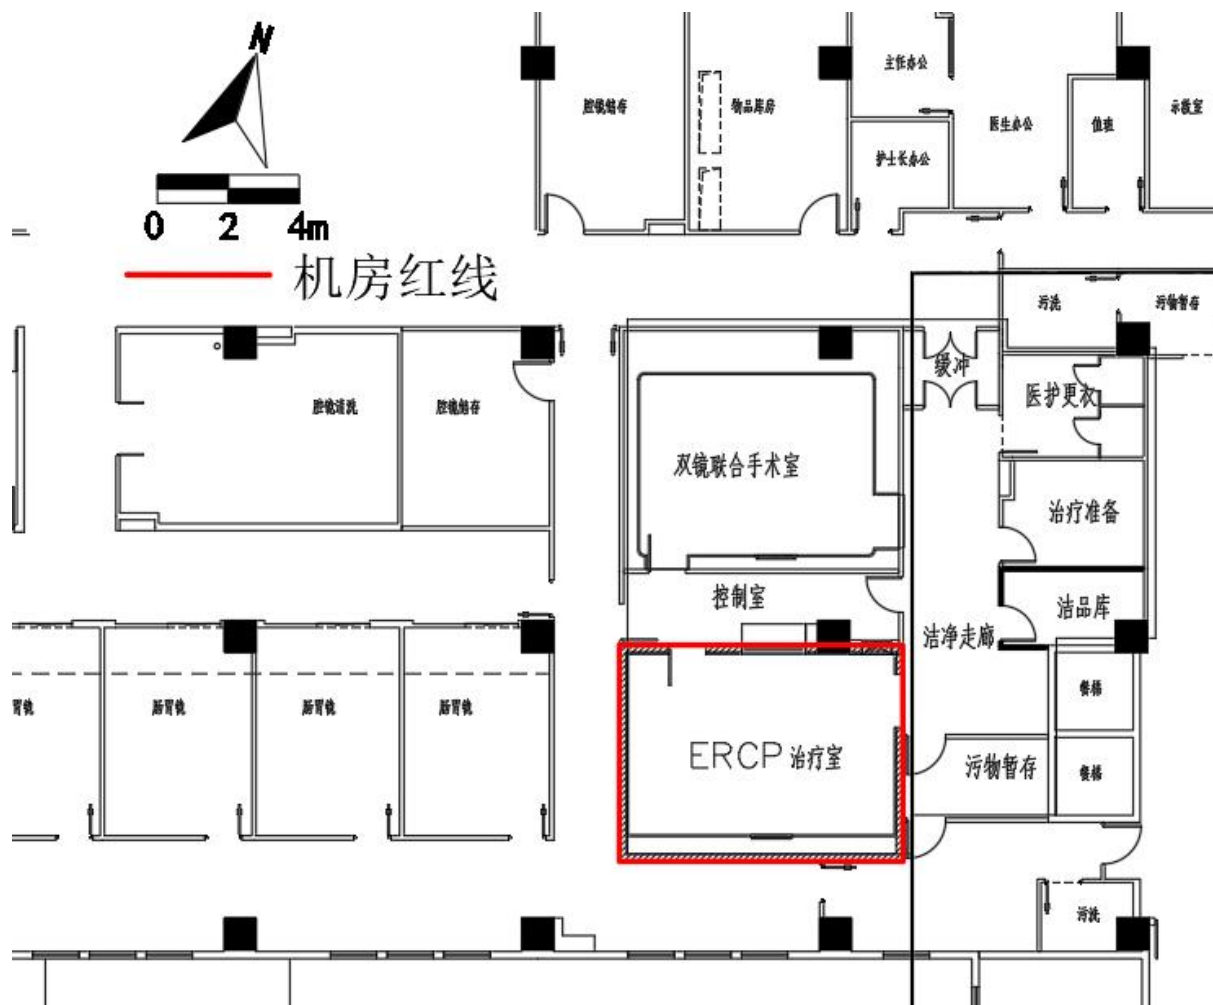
本项目 ERCP 治疗室所在楼层（二层）局部平面布置示意图
